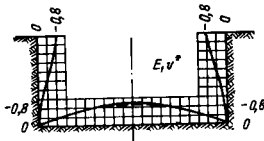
Перемещение стенок и дна ненагруженного котлована под воздействием собственного веса грунта и бокового давления при $\xi_0 = 0.5$. Пунктиром показаны перемещения дна котлована, установленные по схеме боковой пригрузки, приложенной к прямолинейной границе основания
